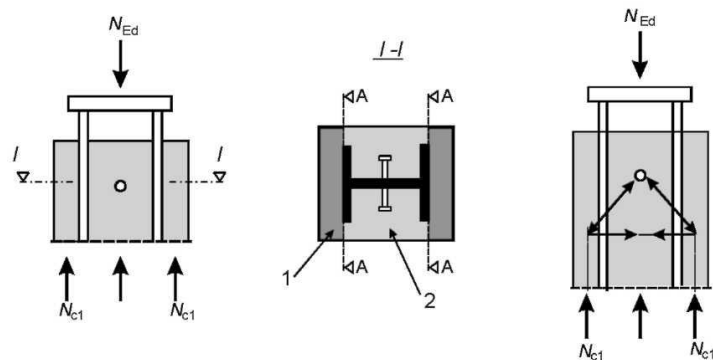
Проектування поперечної арматури з прямим і непрямим з'єднанням бетонних ділянок
